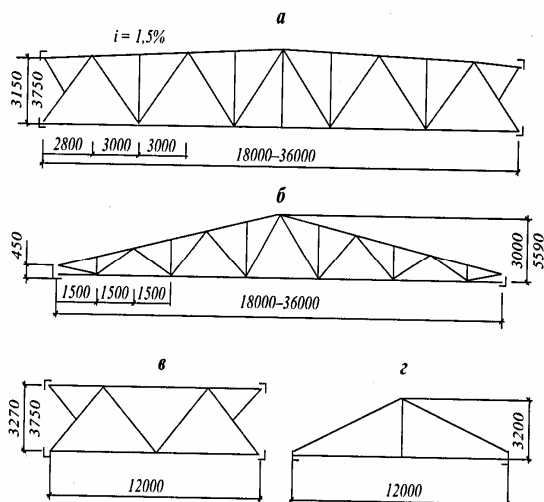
Схемы стальных стропильных и подстропильных ферм:
